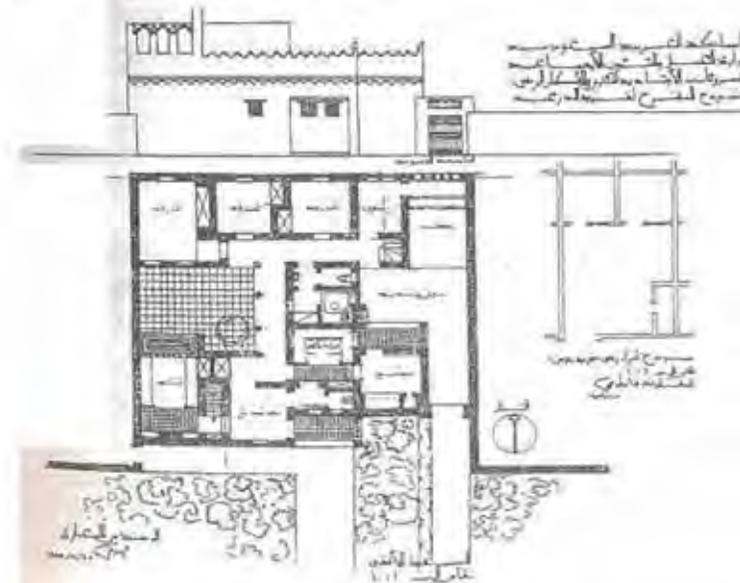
Grundriß, Dachgeschoß und Schnitt von eines Prototyp-Hauses in Saudi-Arabien.
